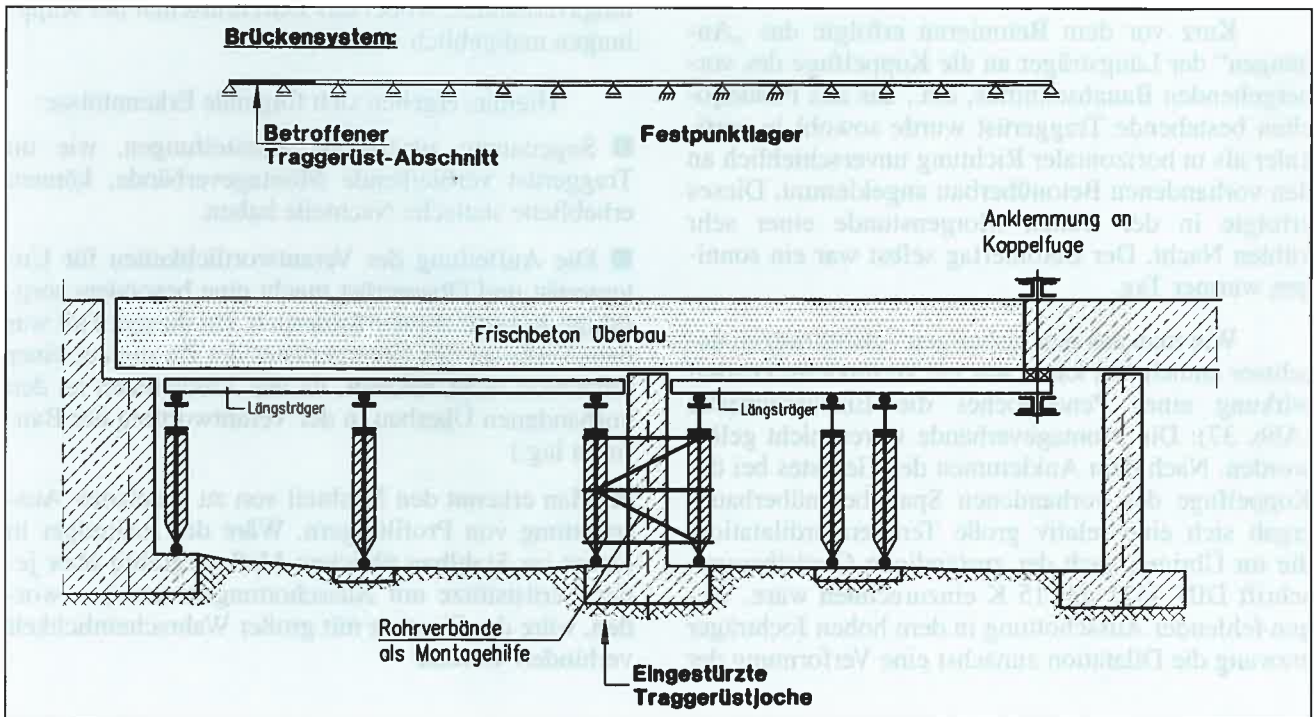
Die horizontale Kopfhalterung der Pendeljoch erfolgt statisch gesehen über Gelenkpunkte an Unterkante Längsträger. Die Längsträger der beiden Brückenfelder sind über dem Pfeiler aneinandergeschnitten. Montageverbände wurden vor Betonieren nicht gelöst.
